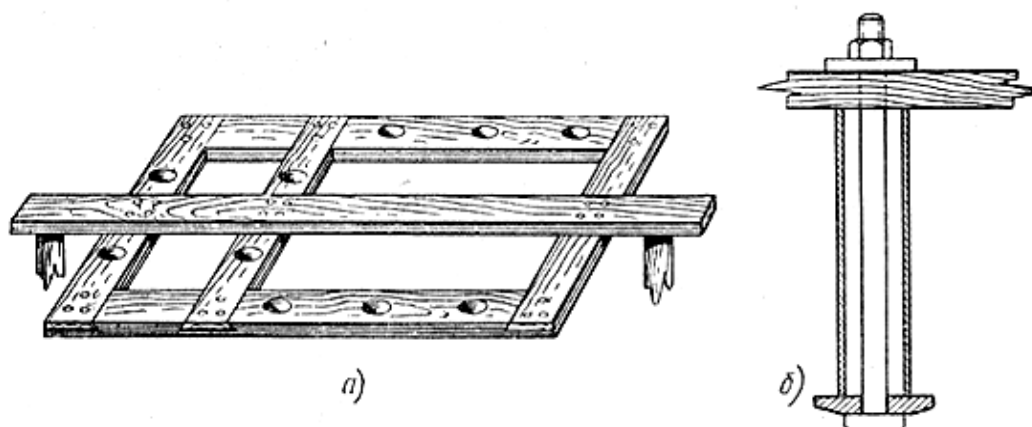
Рама-шаблон для копирования расположения отверстий фундаментных болтов: *а* – рама; *б* – крепление анкерного болта к раме
